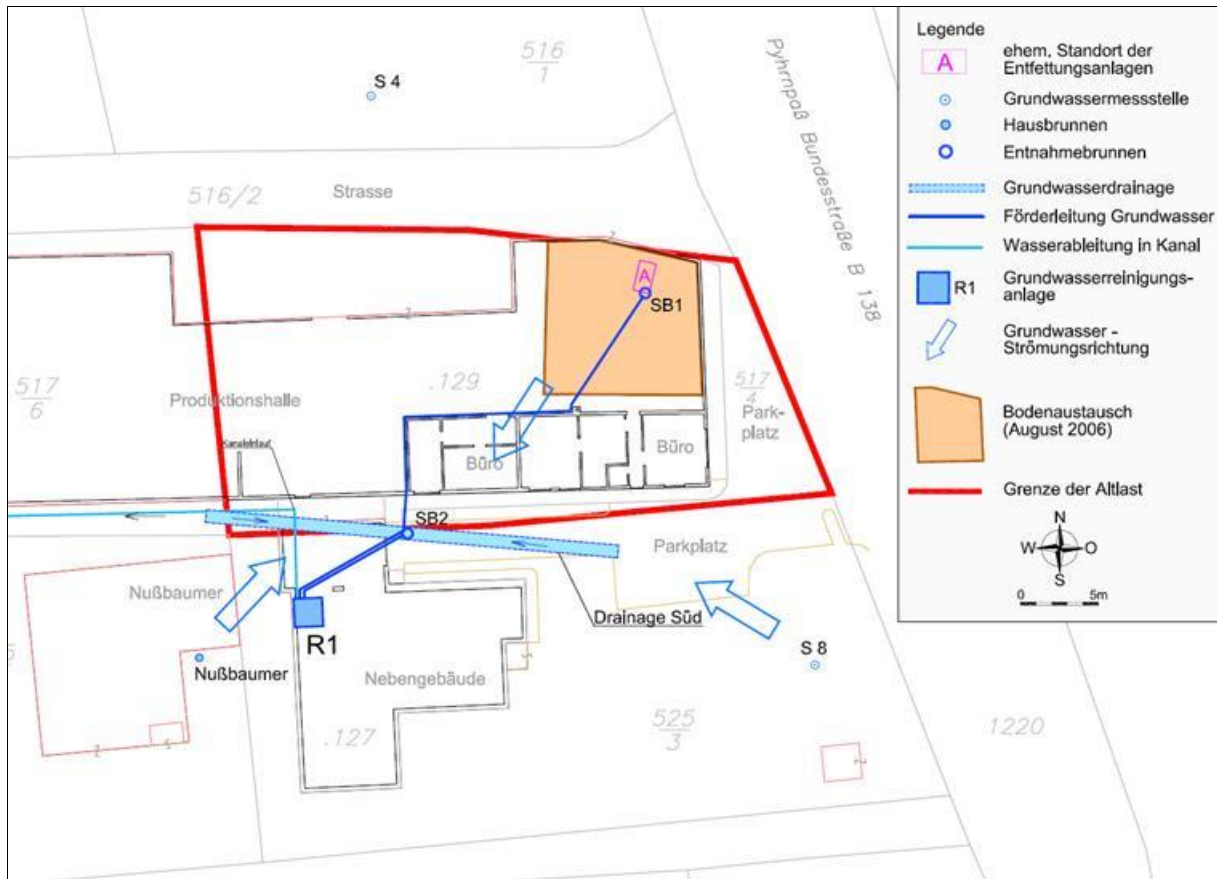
Lage der Grundwasserdrainage, Entnahmehrunnen, Grundwasser messstellen und Brunnen
